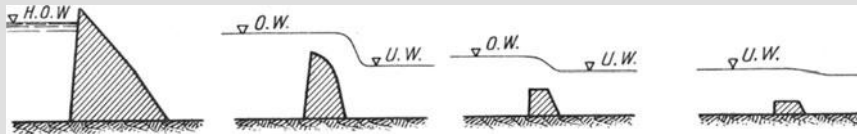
Staudamm. Abb. 308. Überfallwehr. Abb. 309. Grundwehr. Abb. 310. Grundschwelle.
